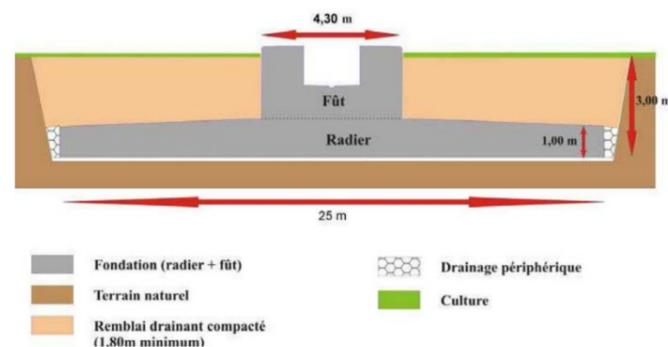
Coupe de principe d'une fondation (source : Quénéa, 2020)
